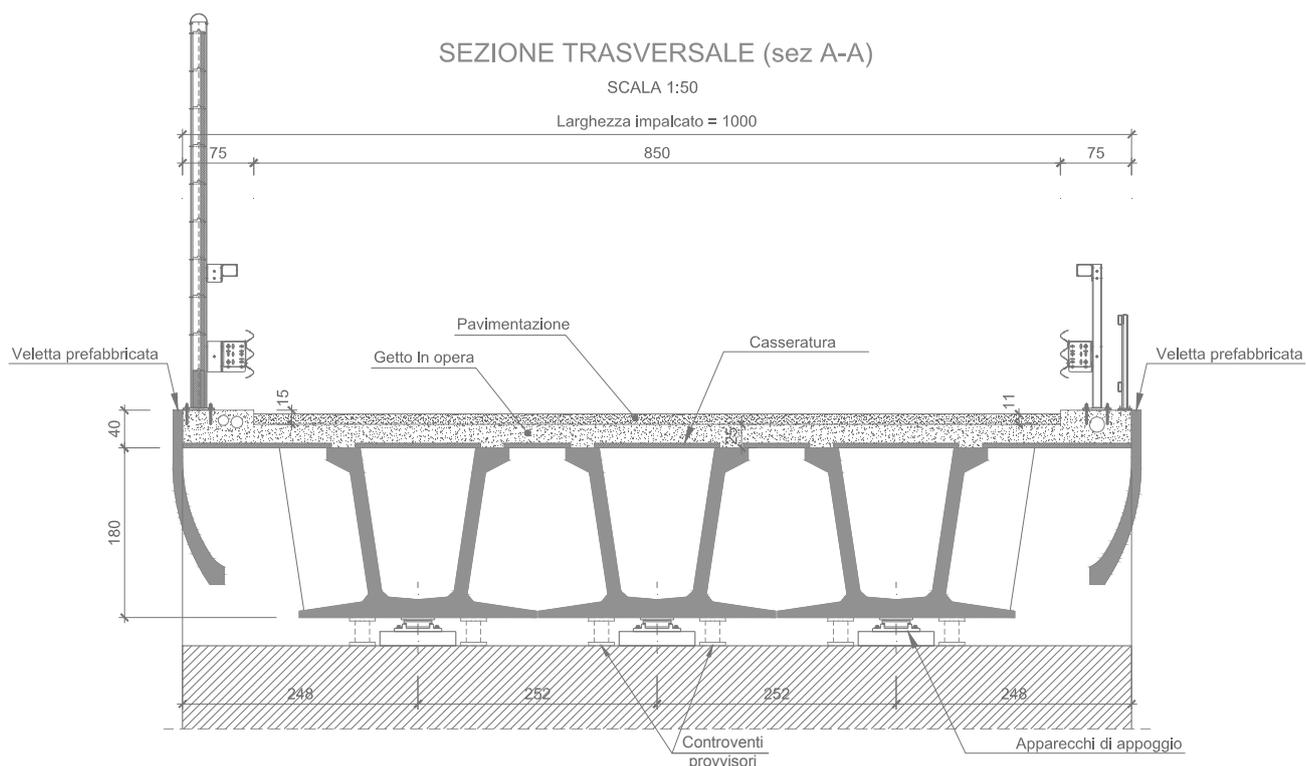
Sezione trasversale Ponte Torrente Chiavon Complanare
